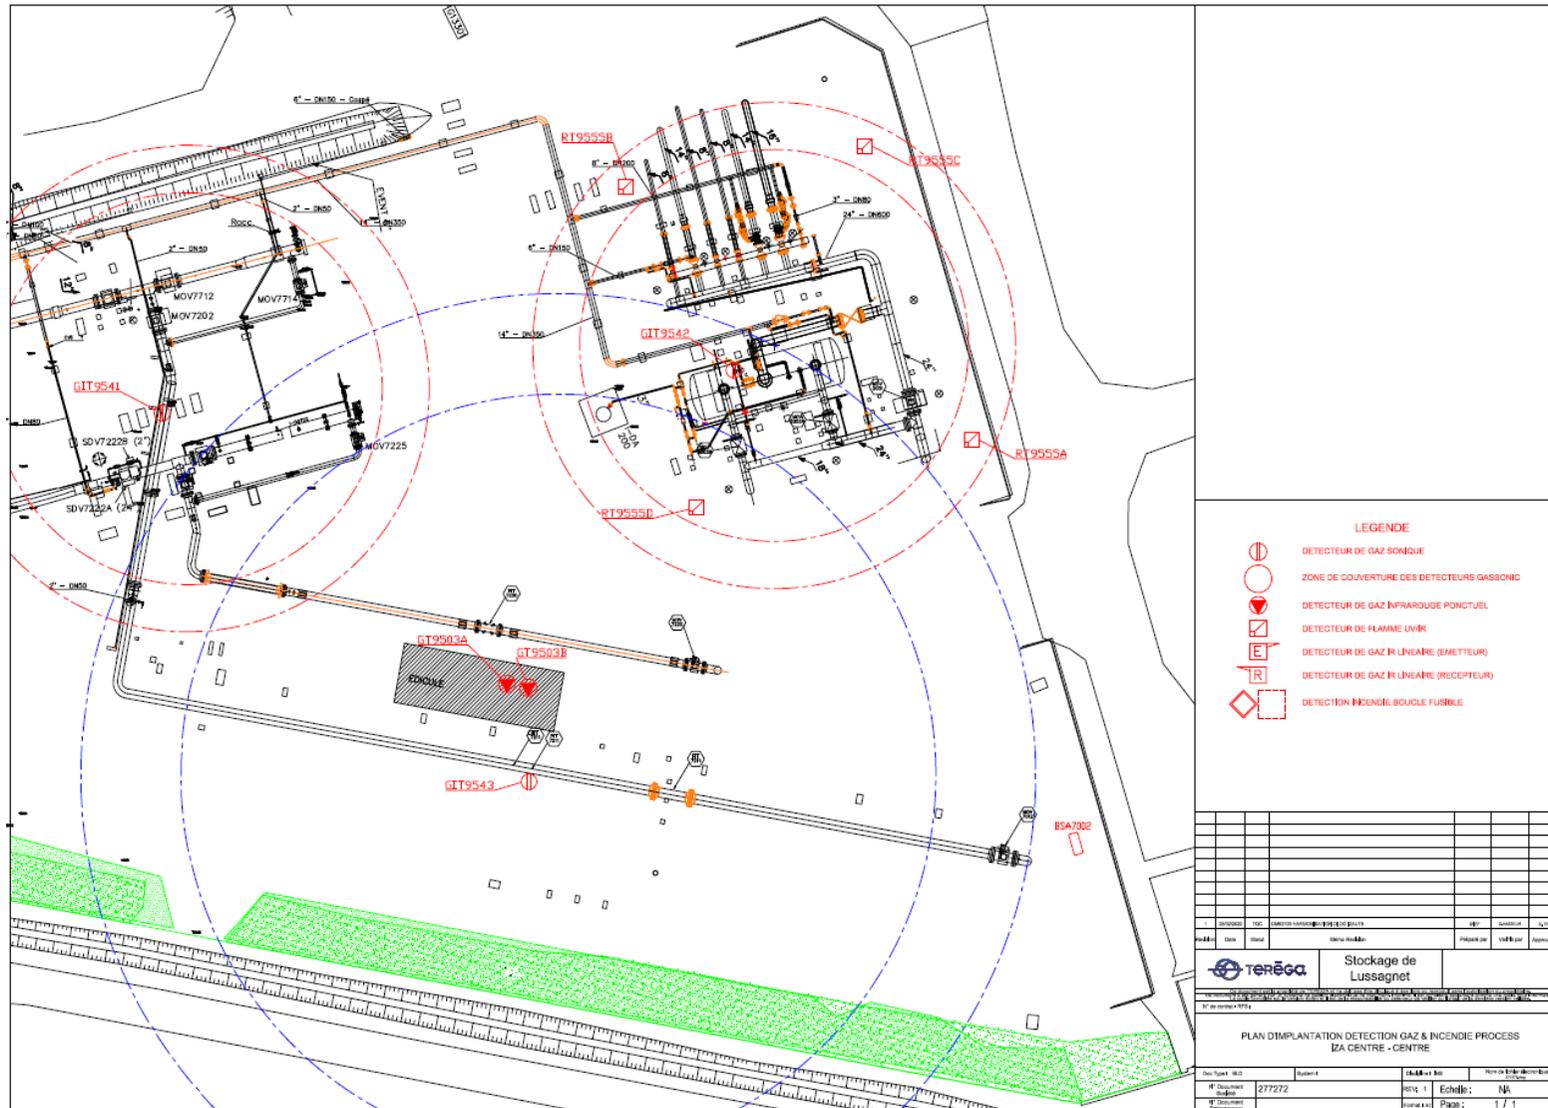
Plan d'implantation des détecteurs sur le centre de regroupement
